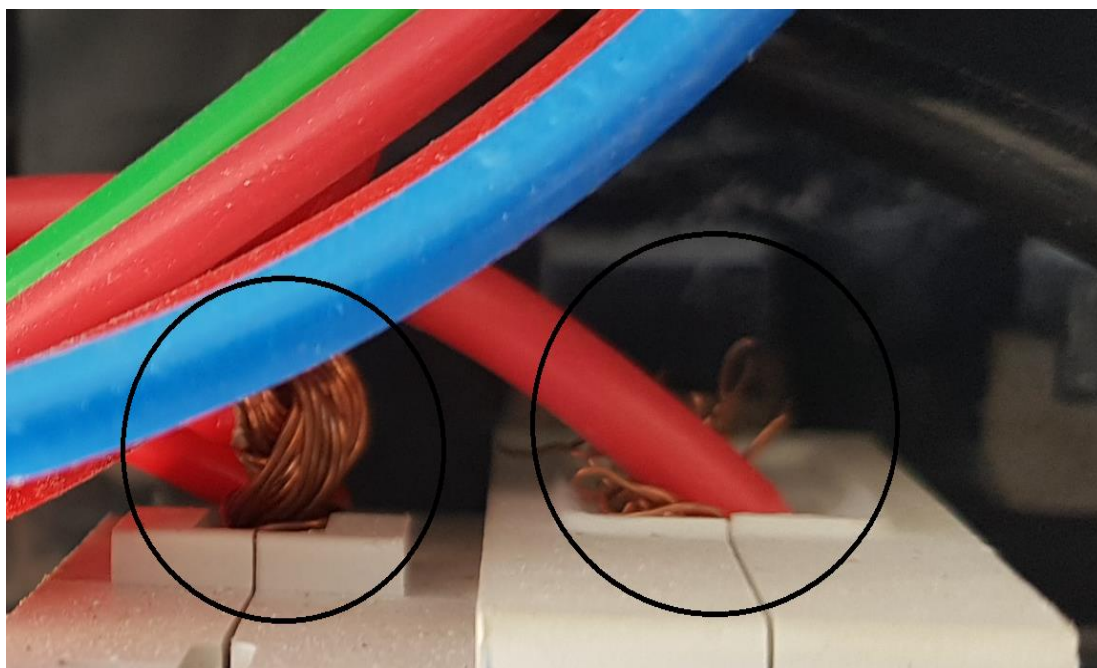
Conexão mal feita, ponto de aquecimento e risco de choques – Fonte Autor
